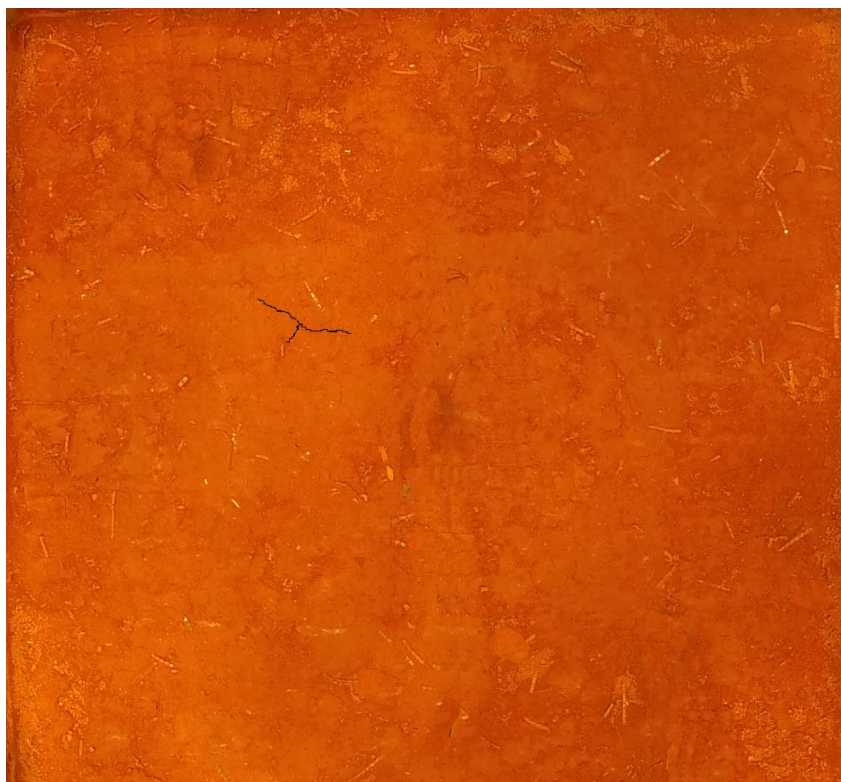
Primeiras fissuras da amostra PET.
